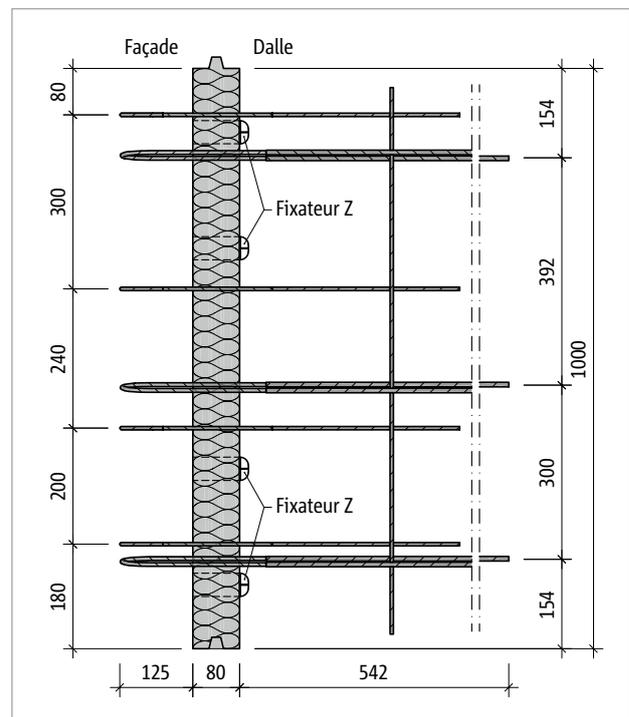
Schöck Rutherma® T type DFi-V3-LR125 : vue en plan du produit
